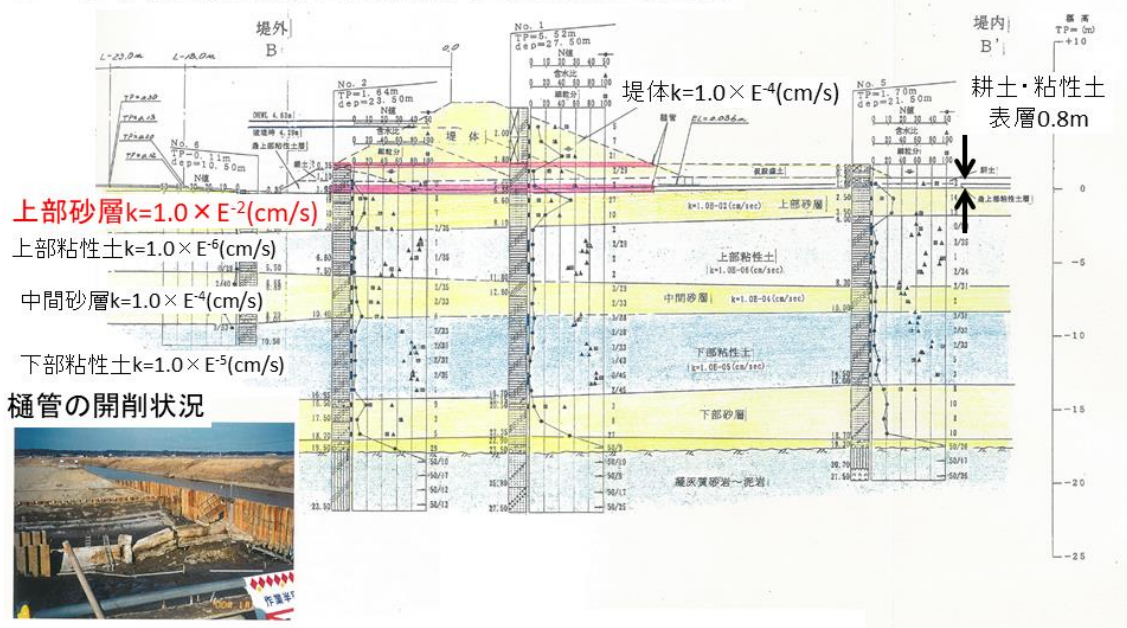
ボーリング及び開削調査により推定された土層構造
